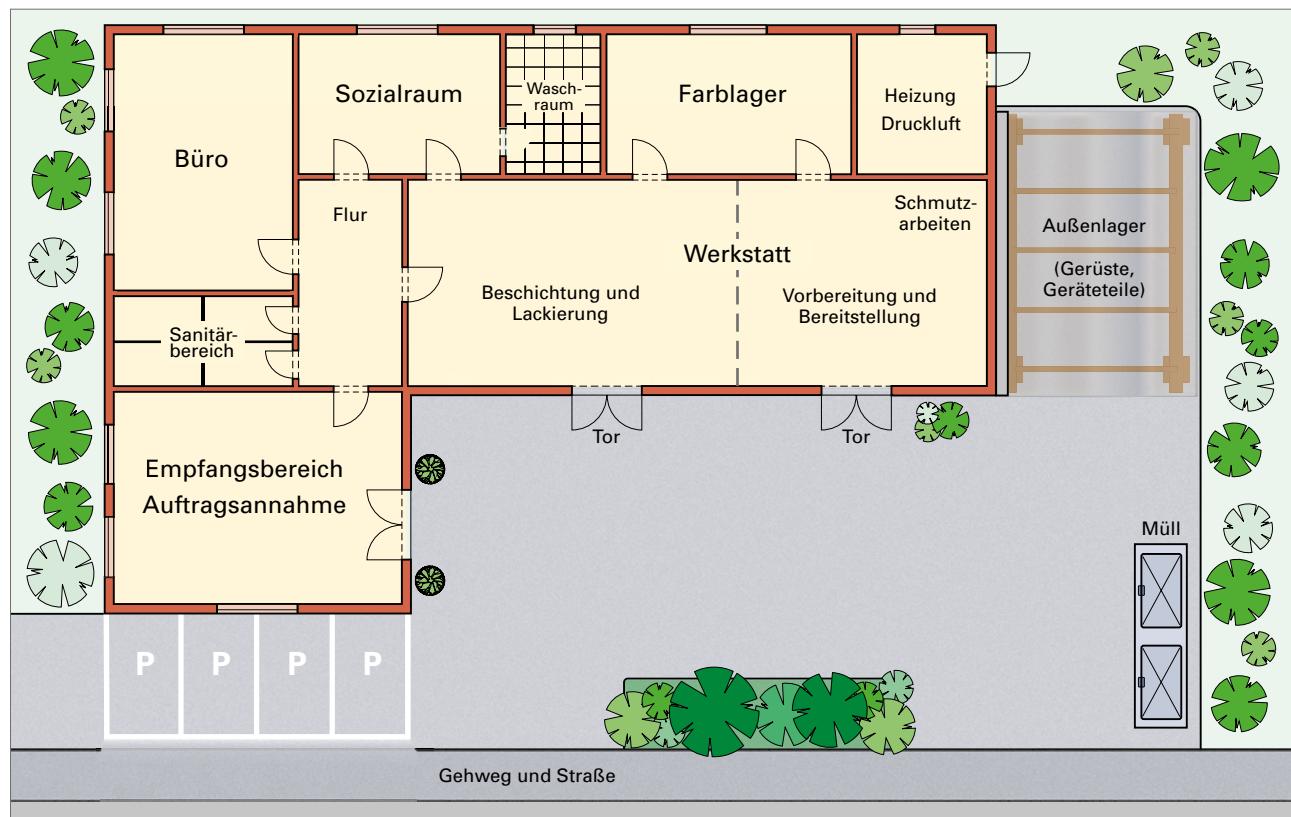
Möglicher Grundriss eines Malerbetriebes
